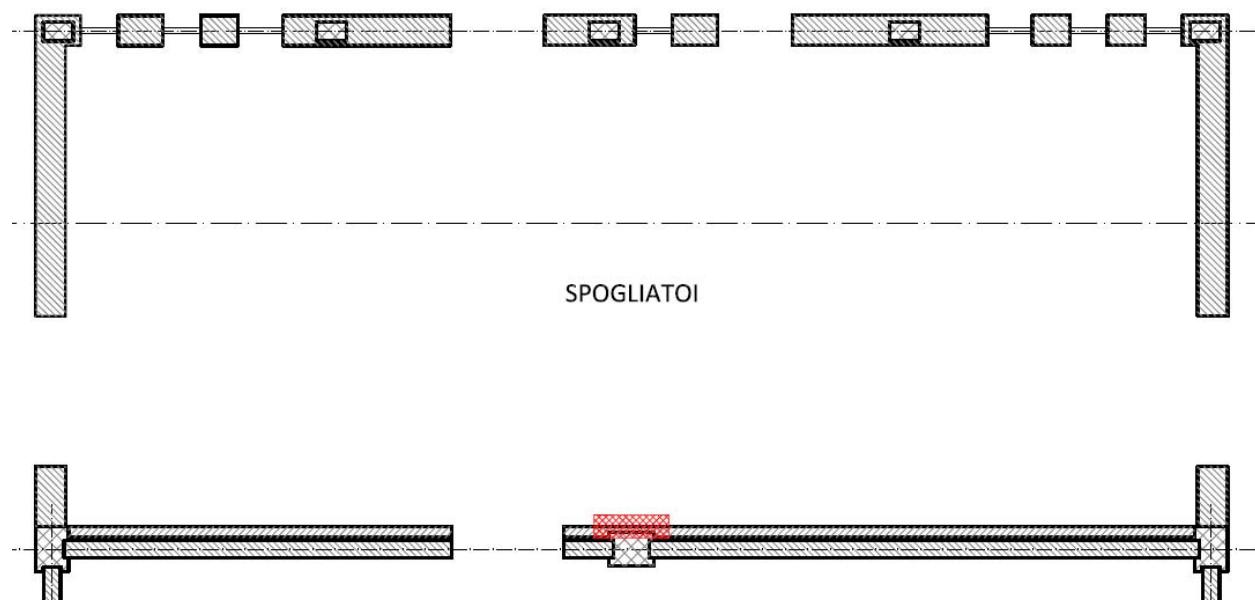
Intervento 10 – Individuazione in pianta dell'intervento
